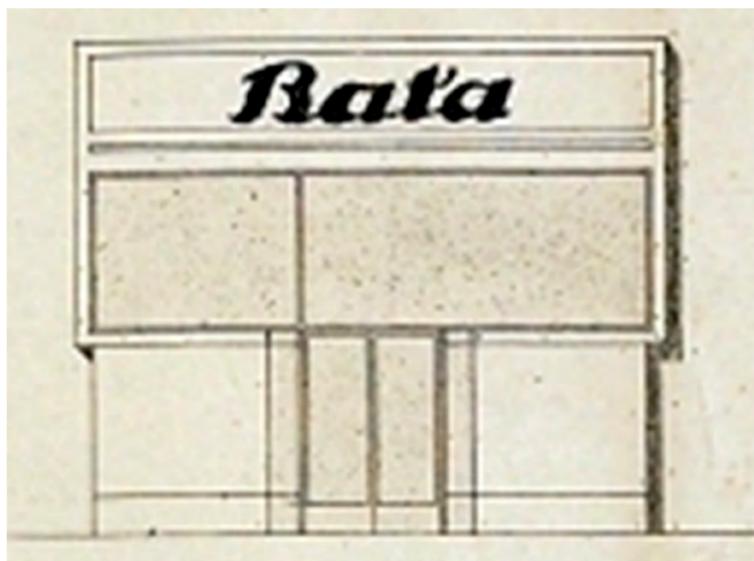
FLC 17812: Detalle parcial. Alzado Tipo 2, Modelo 8. Tipografía oficial de Bat'a.
